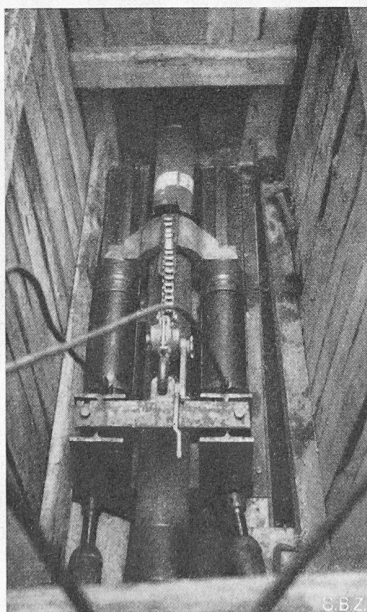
Horizontalbohr-Installation in gepriesstem Schacht
